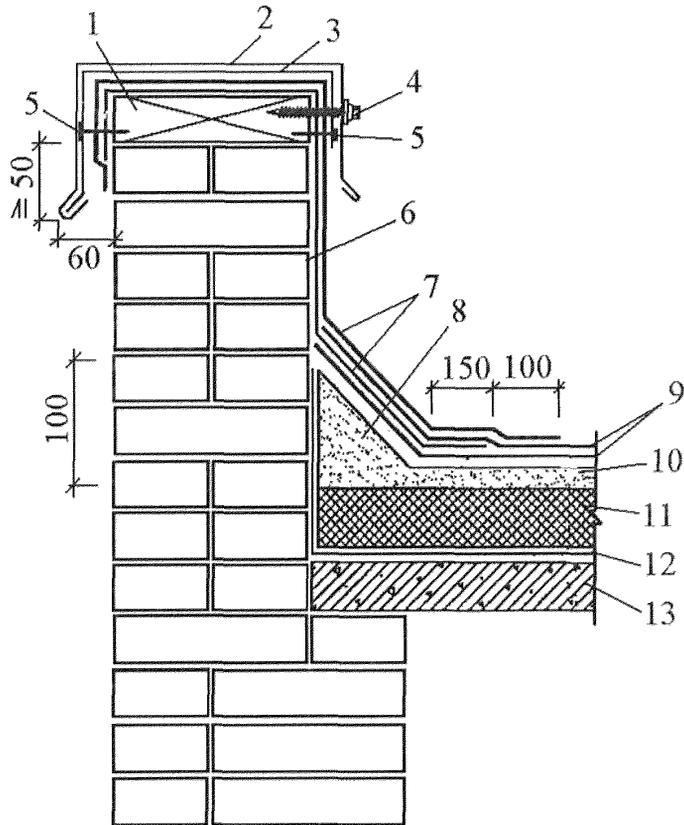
Пример примыкания водоизоляционного ковра к парапетной стене высотой менее 450 мм:
